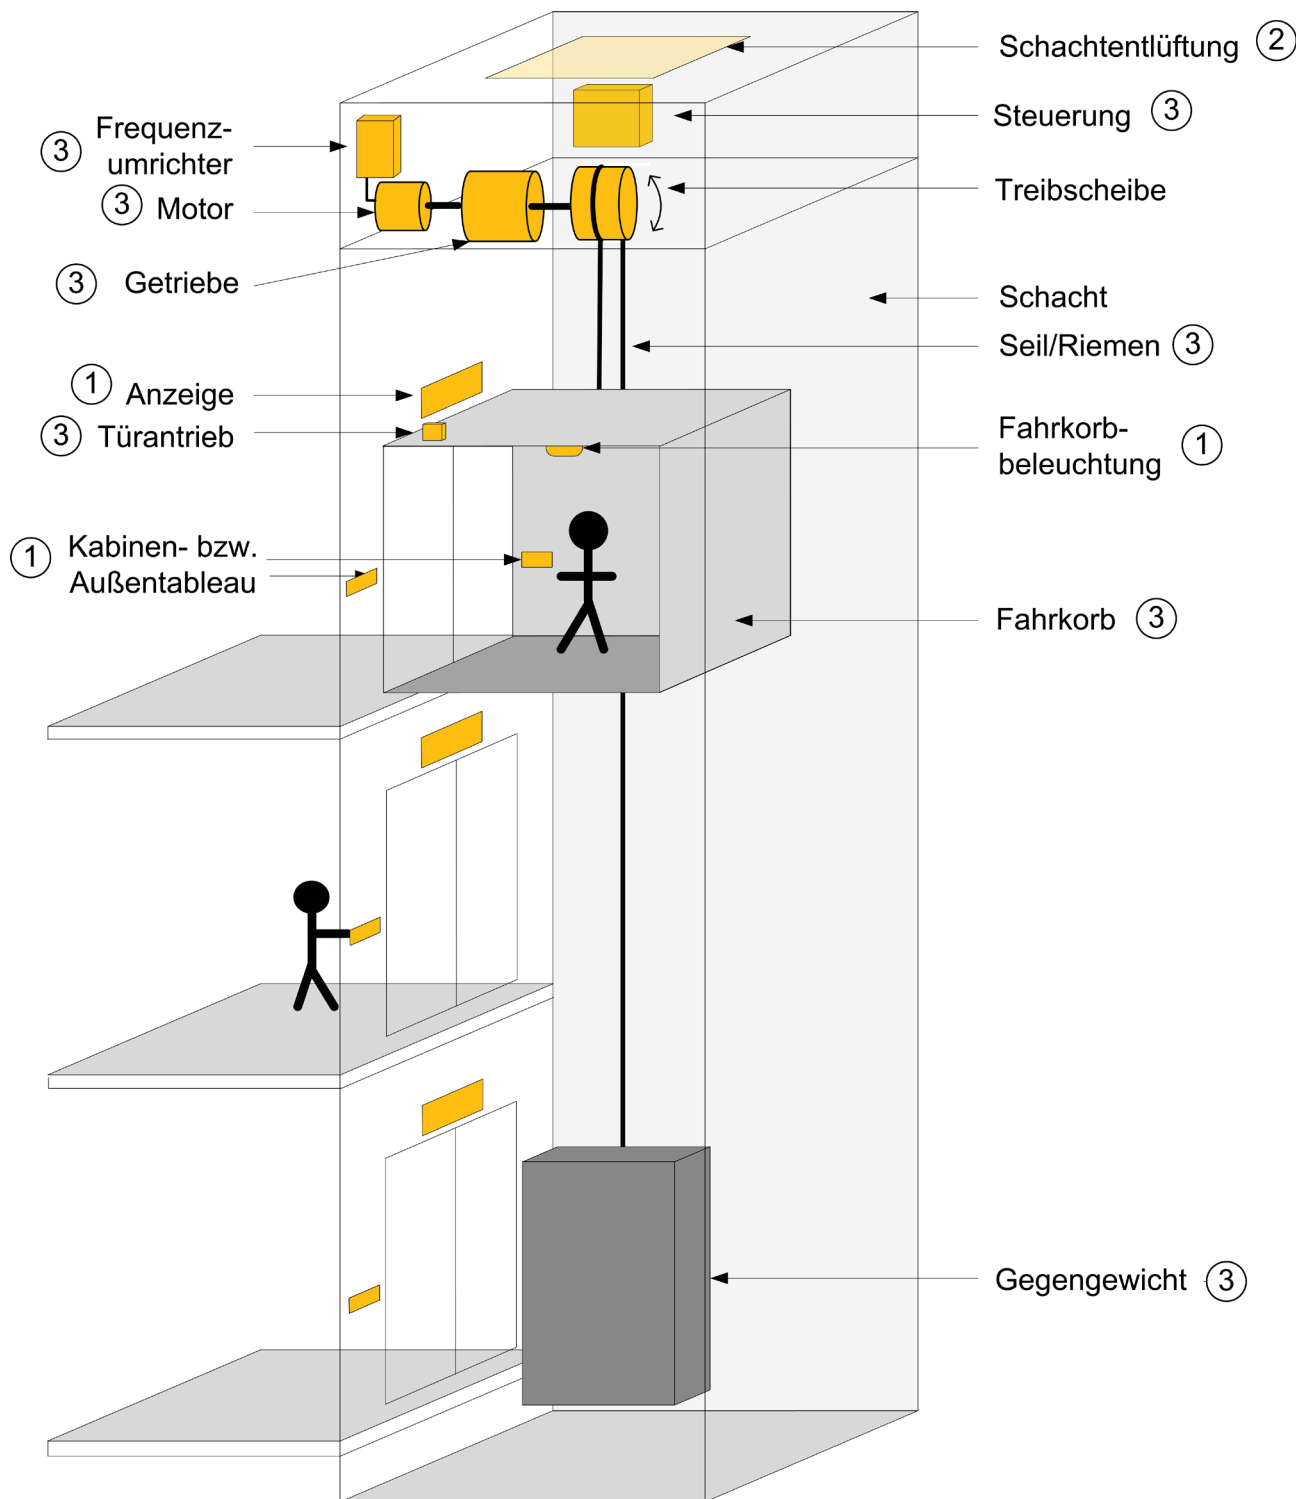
Komponenten des Referenzaufzugs (hier: Seilaufzug) – Übersicht
